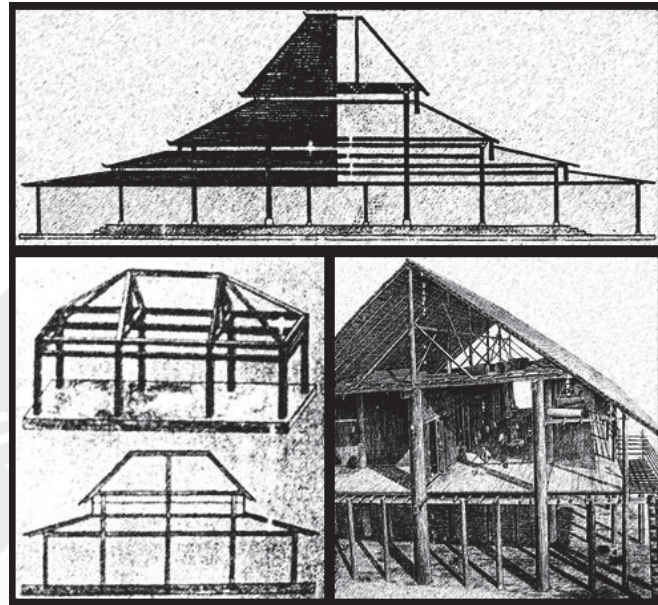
Sub-Struktur Horisontal – *Space Truss (one way)
